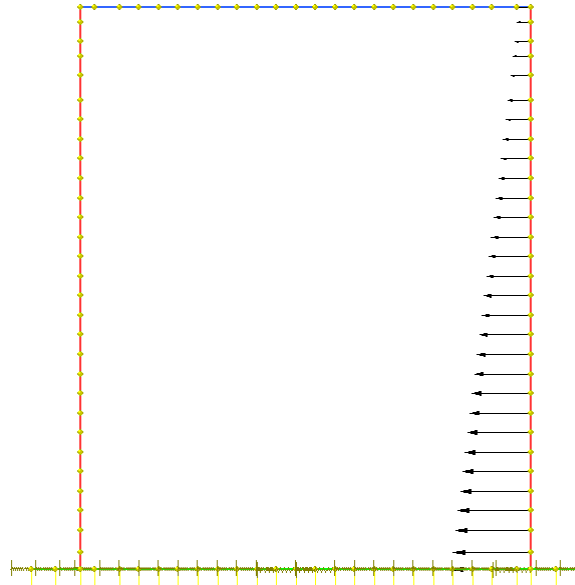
SPINTA A RIPOSO DELLE TERRE SUL PIEDRITTO DESTRO FALDA BASSA (CDC 7)
